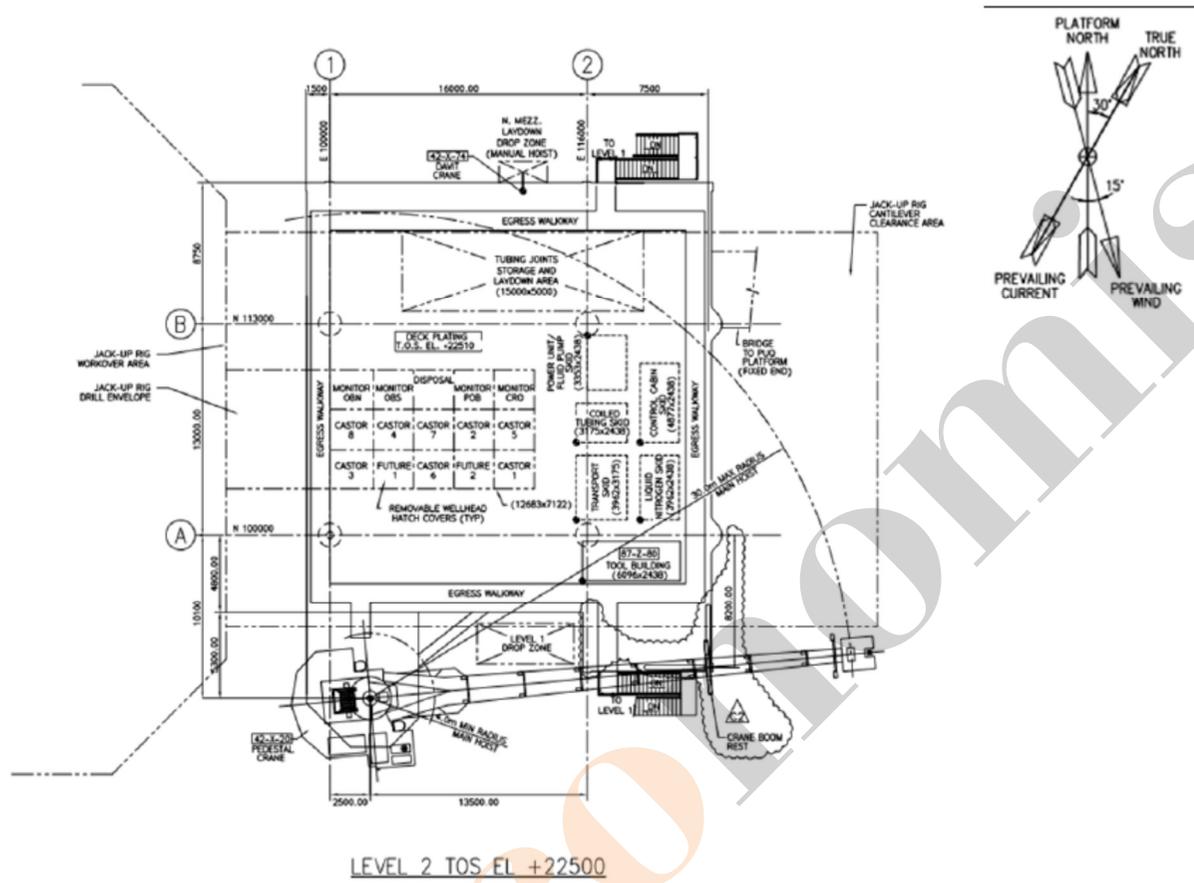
Vista en planta de la Plataforma de pozos (WHP)
